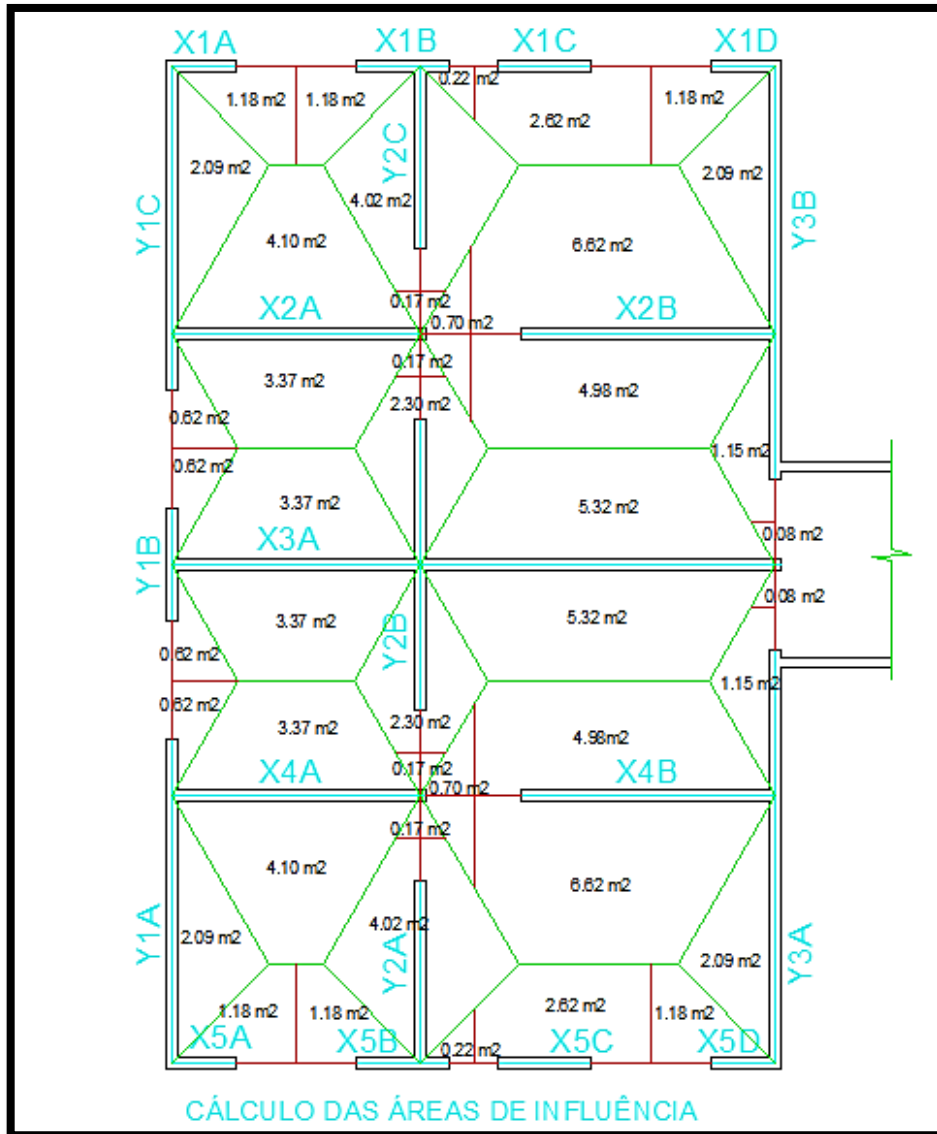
Planta baixa do pavimento tipo com as áreas de influência
